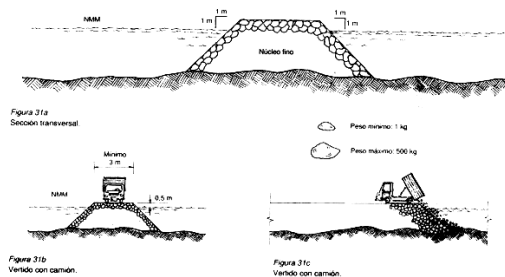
Sección y vertido de piedra para el núcleo fino.
